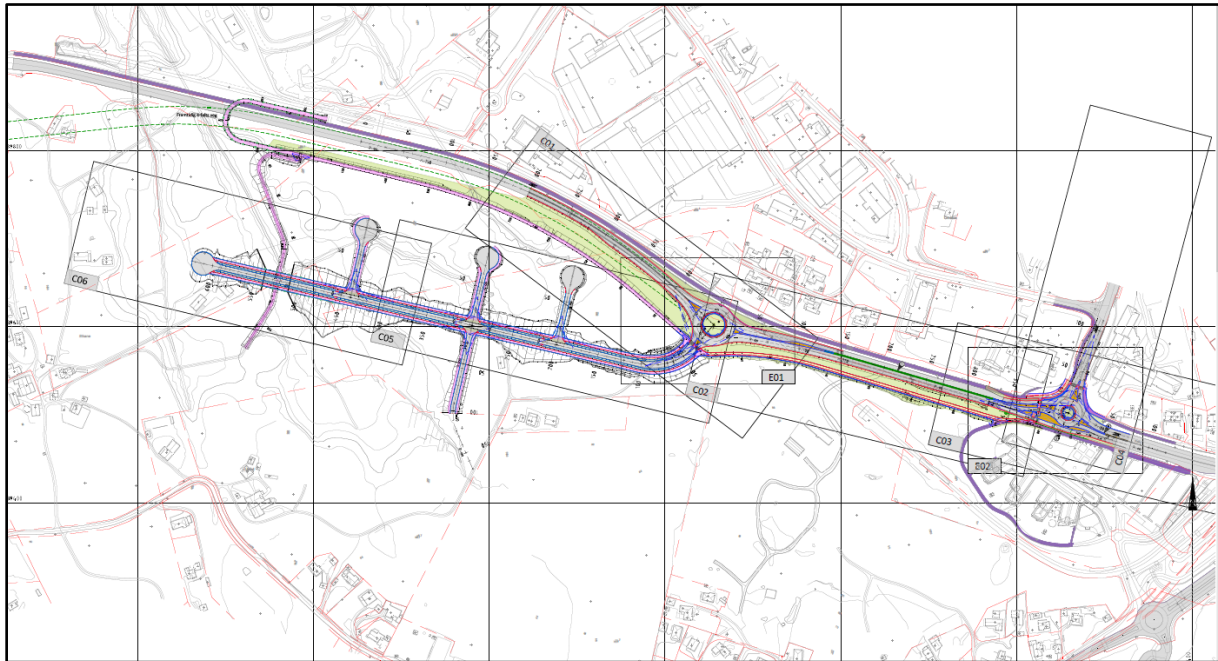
Første forslag til adkomst til planområdet. Illustrasjon: Sivilingeniør Helge Hopen As
